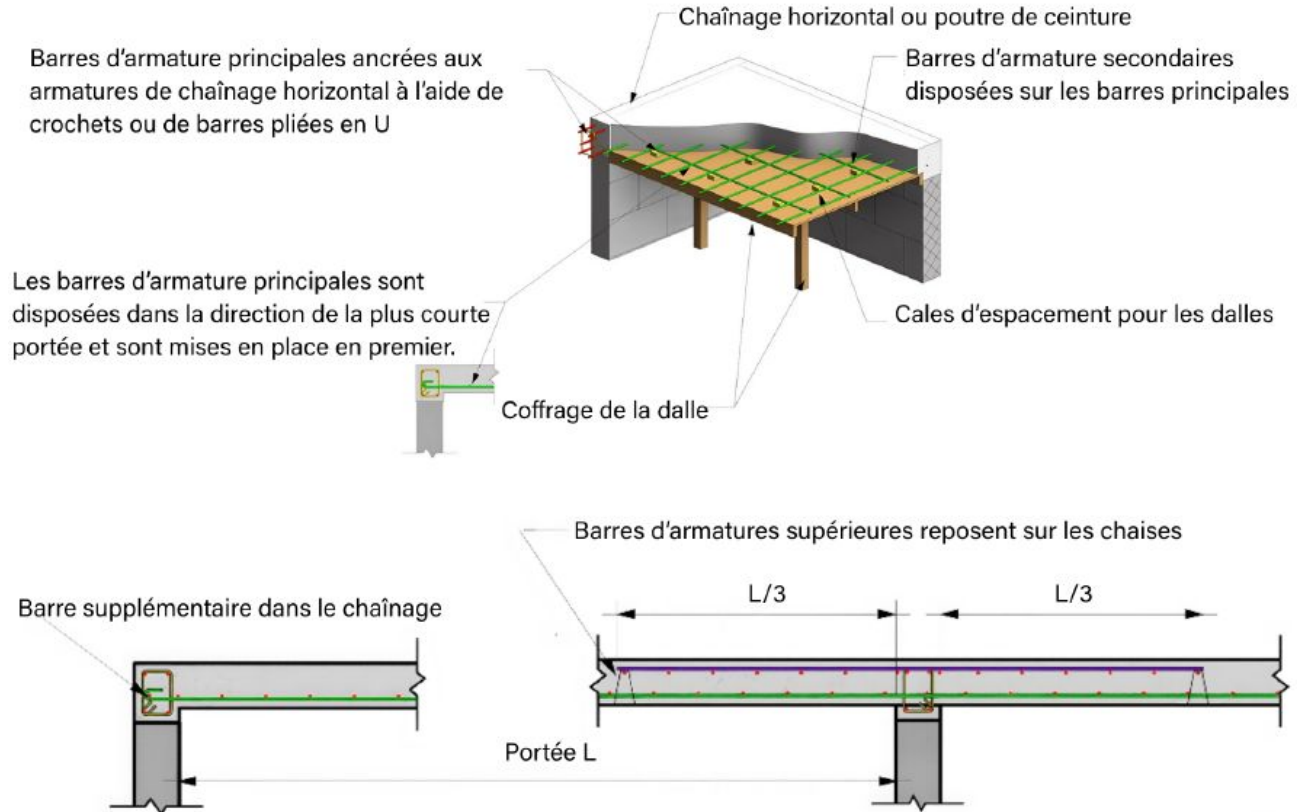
Armature d'une dalle de portée simple.
